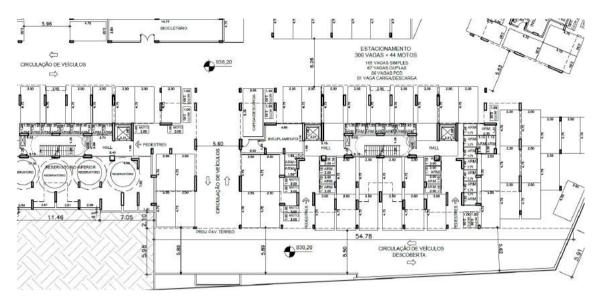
Projeto – 1º Subsolo – detalhe. (Para melhor visualização ver anexo correspondente).
